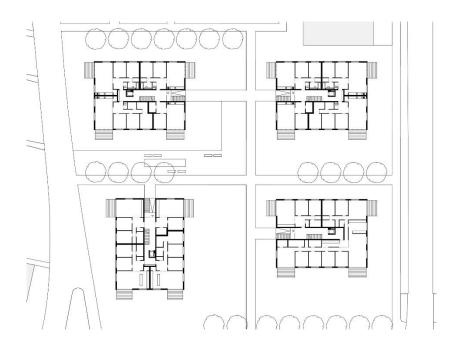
Grundriss Mühlweg Bauteil C129
